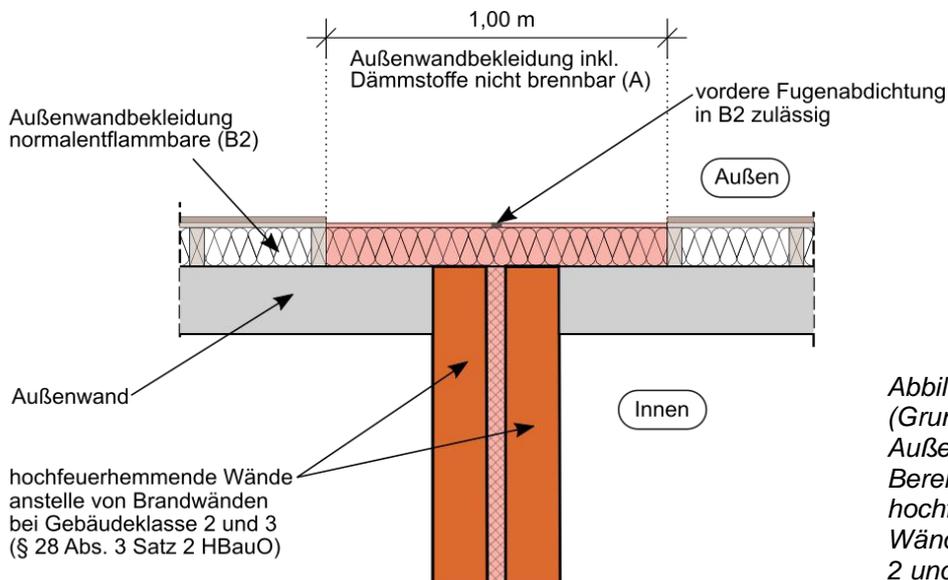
Prinzipskizze (Grundriss) Außenwandbekleidung im Bereich anschließender hochfeuerhemmender Wände bei Gebäudeklasse 2 und 3
